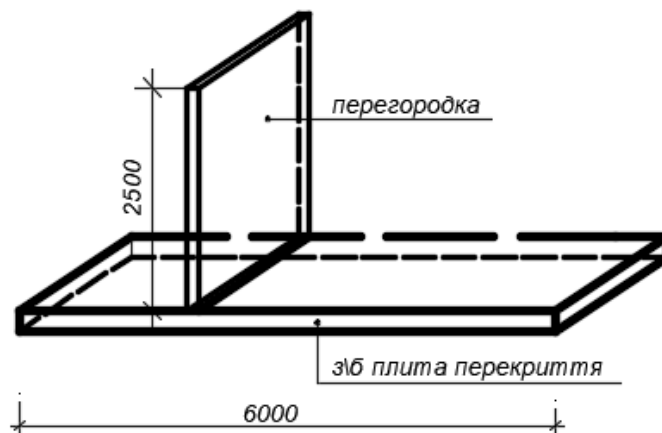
Перегородка, яка розташована поперек плити перекриття
